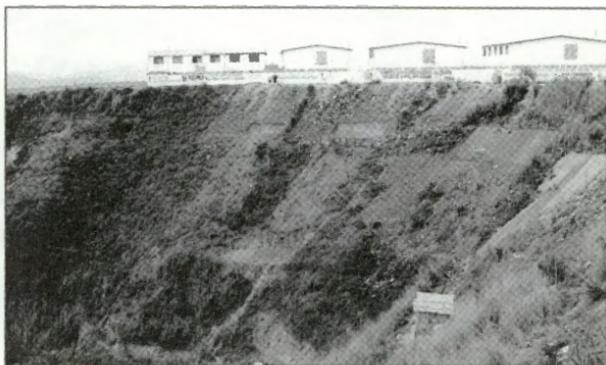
Inicio de la excavación para el banqueo o primera terraza donde construirán la casa
